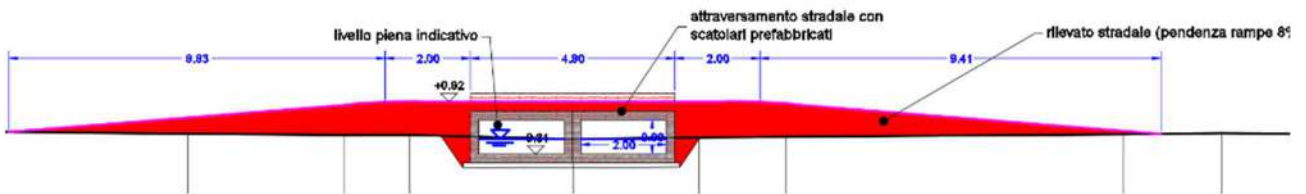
Sezione tipo attraversamento scolmatore. (rappresentazione non in scala)
